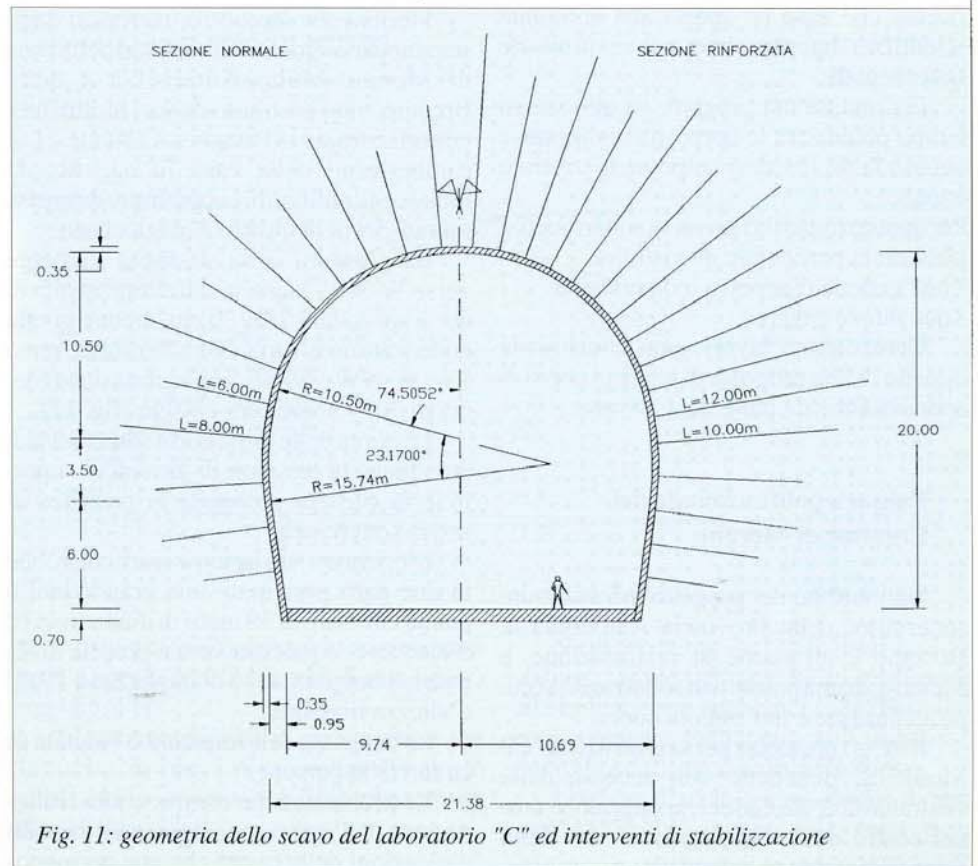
geometria dello scavo del laboratorio "C" ed interventi di stabilizzazione
